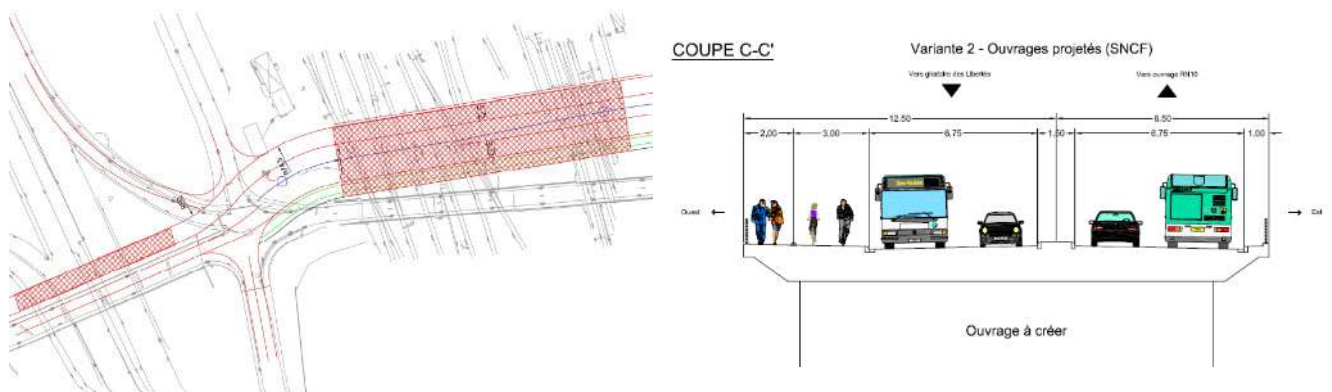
Tracé en plan et profil en travers de l'option de création d'un ouvrage de franchissement des voies SNCF entièrement neuf
